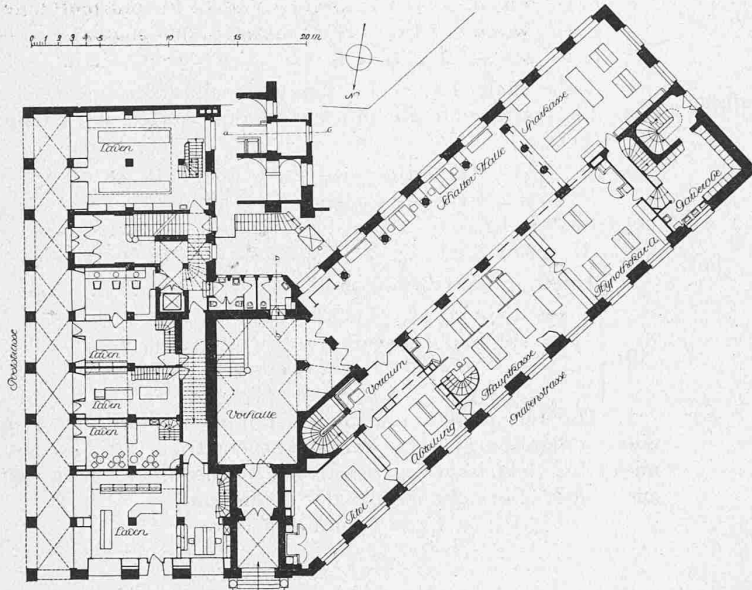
Grundriss vom Erdgeschoss. — 1:500.
